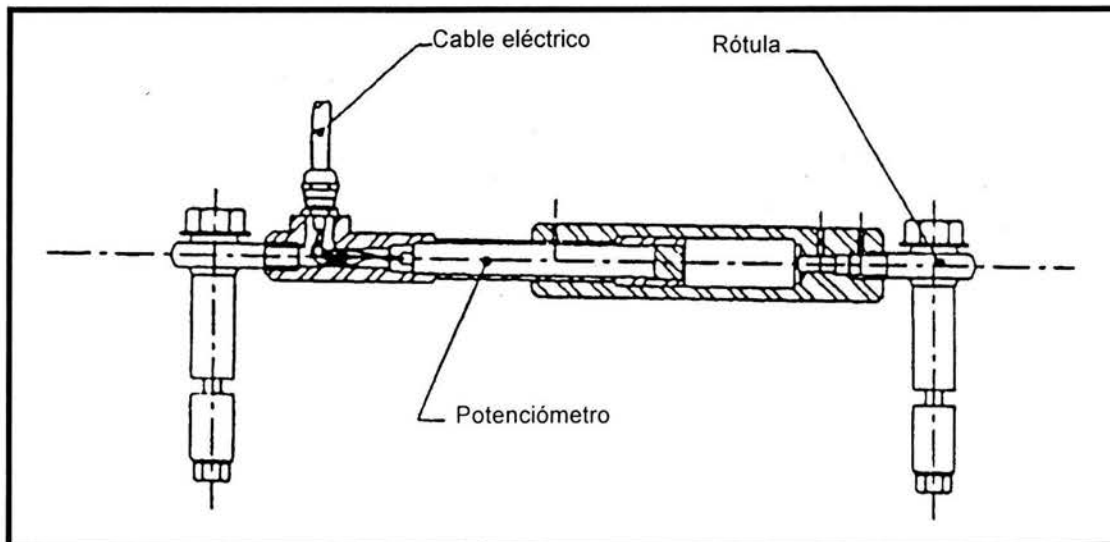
Medidor de grietas fijo
